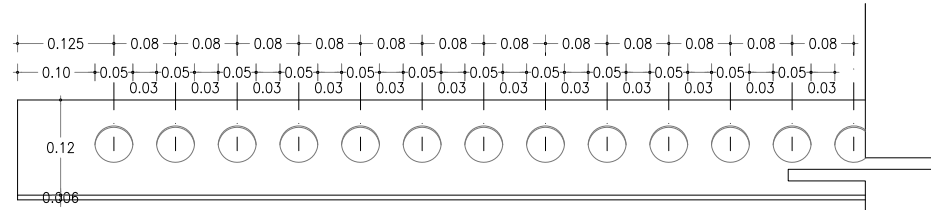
Detalle de vigueta tipo omega Ω con losa prefabricada
